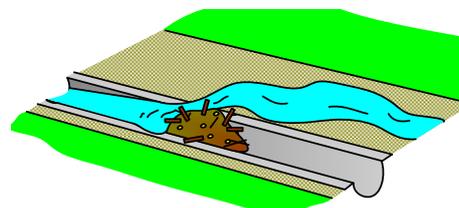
Canal abierto y sistema de canal combinado (Fuente: JCT)
